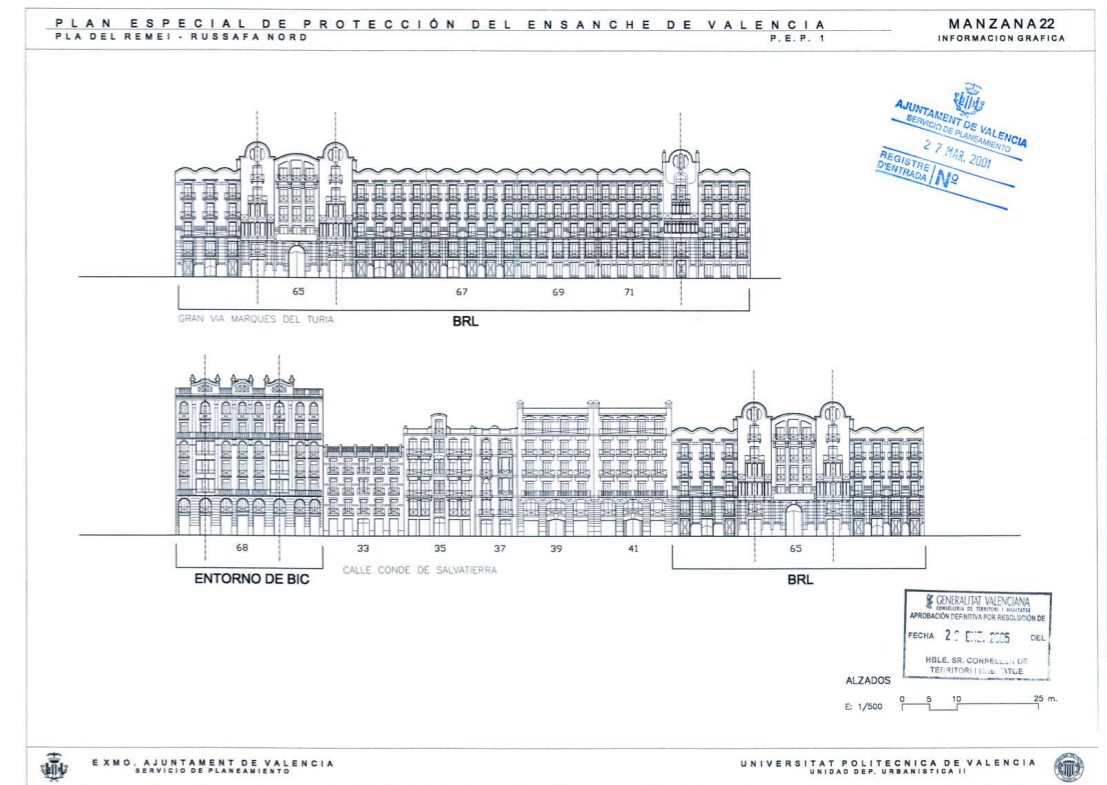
Plan de protección especial del ensanche de Valencia. Ficha del manzana. Alzados
